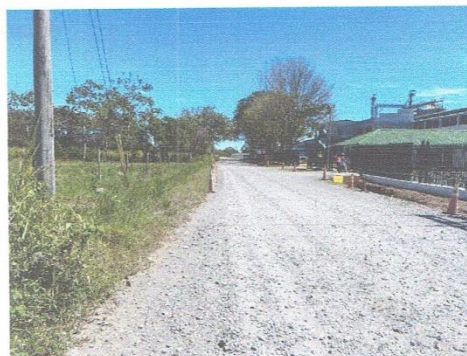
Vía sin un sistema de drenaje pluvial definido.
